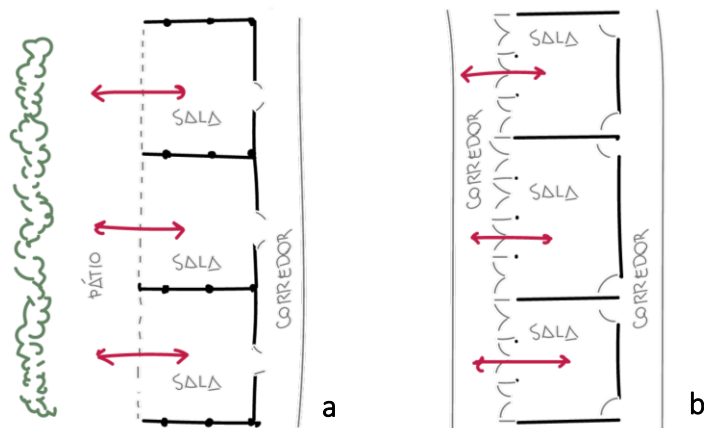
Plantas escolas Richard Neutra e Lele, respectivamente
